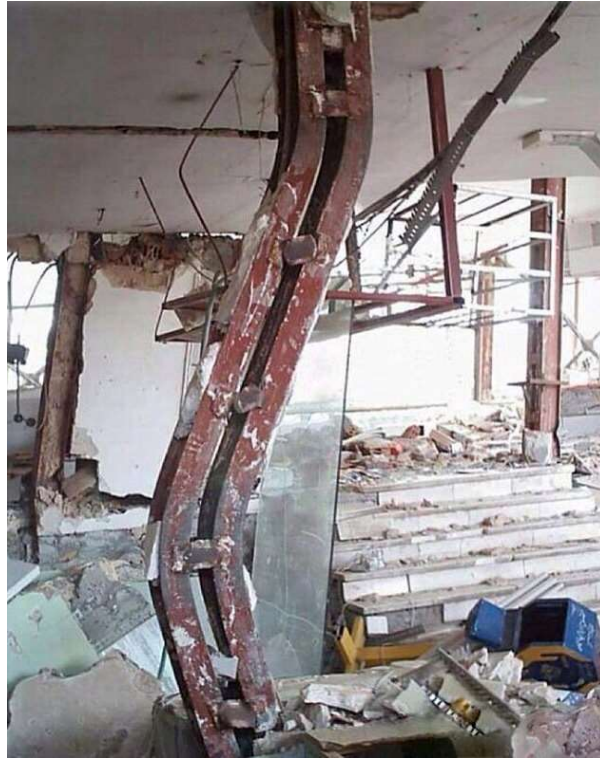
Ejemplo de pilar afectado por pandeo[2]
